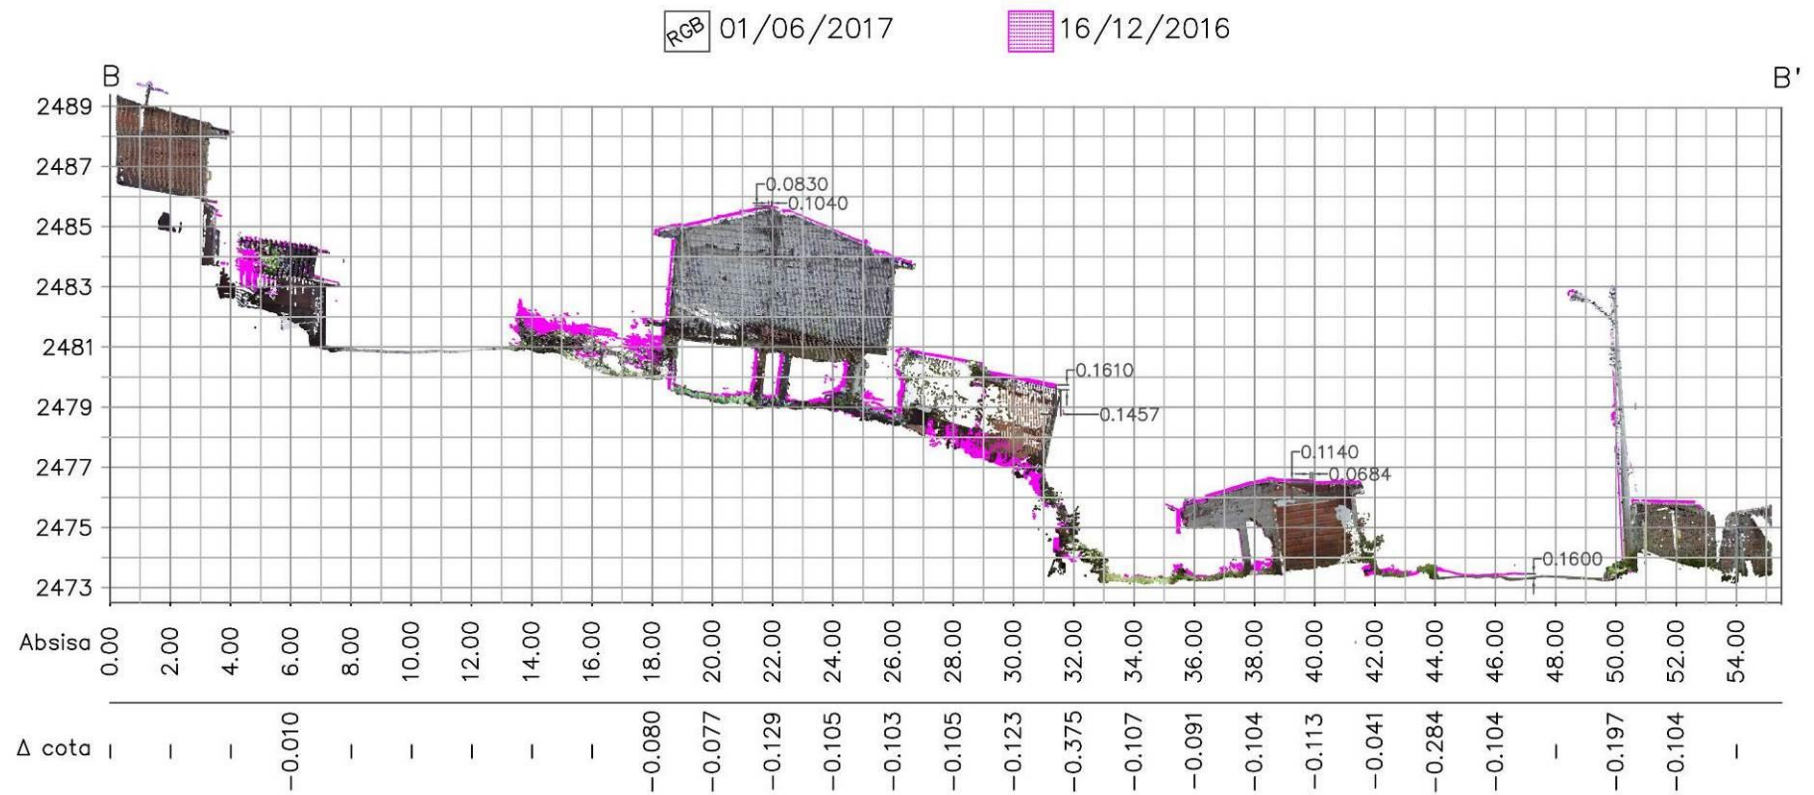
Levantamiento 1 vs levantamiento 2, perfil B-B'.
